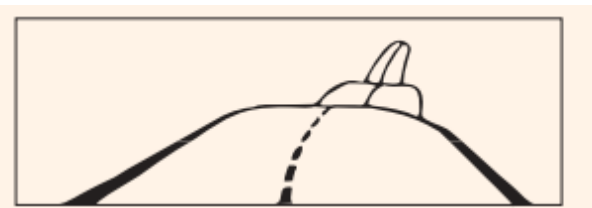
Situación a evitar en la coordinación planta alzado (III)
